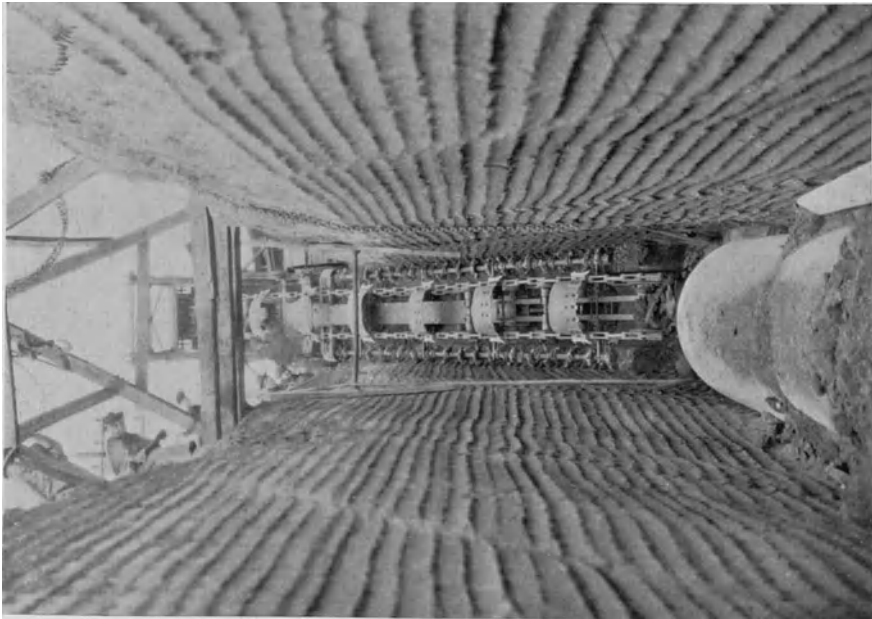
Buckeye-Grabenbagger mit einfachen Messerwellen.
